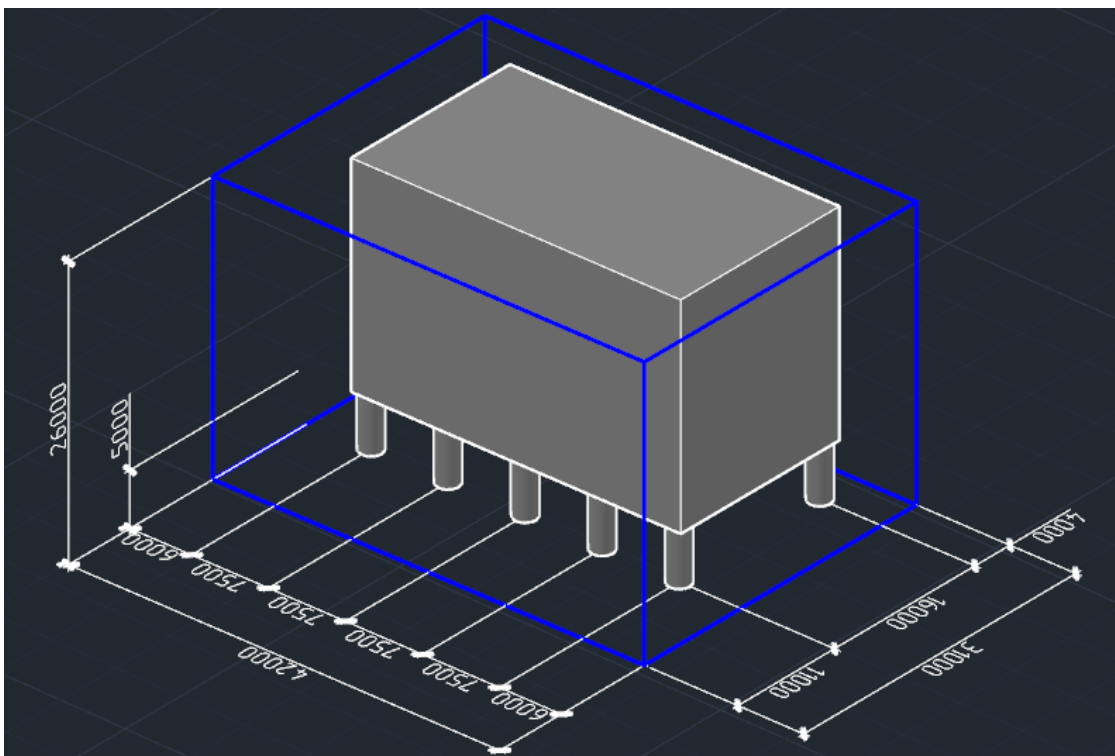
Расчетная схема здания с открытым нижним этажом
